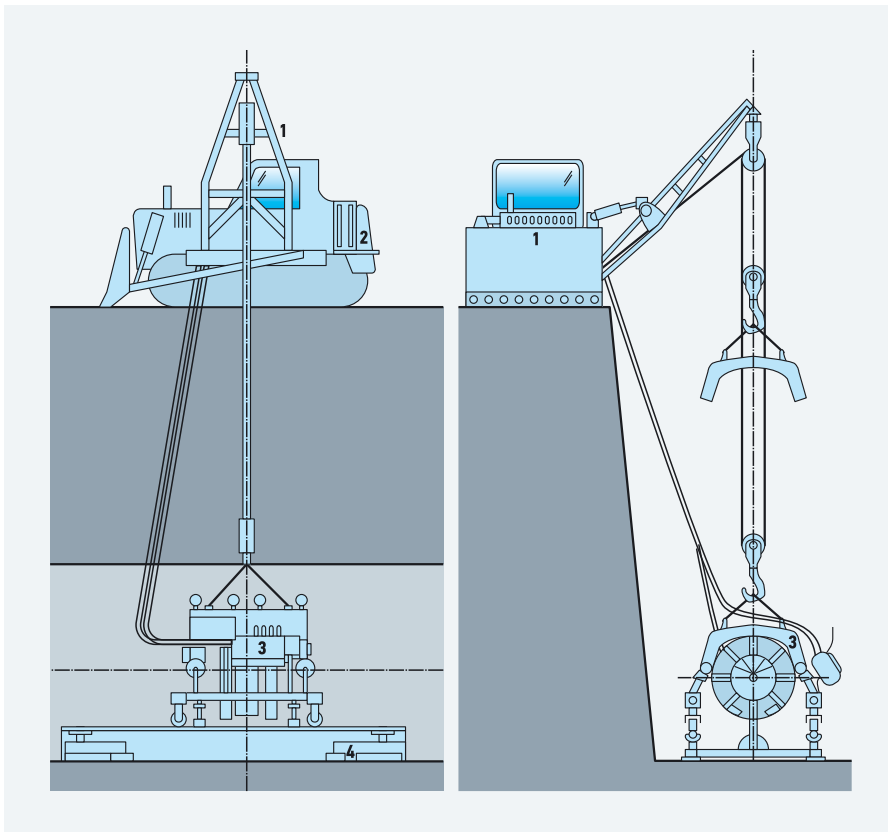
Механизированная установка для сварки труб из ПВД диаметром 710–1200 мм (НИИ Мосстрой, СКБ «Мосстрой», ПО «Мосремстроймаш»; 1 — трубоукладчик-бульдозер; 2 — электрогенератор; 3 — сварочная установка; 5 — опора; 6 — направляющая)
